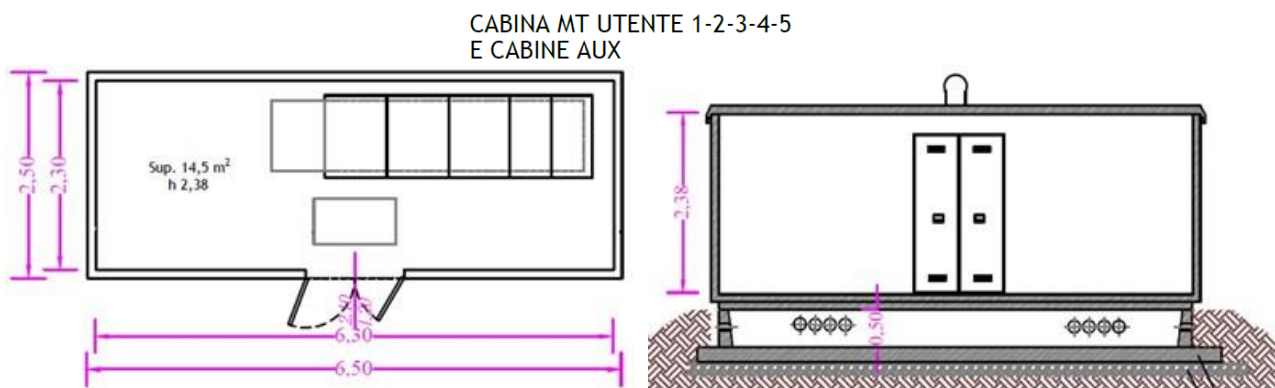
Pianta e profilo delle cabine MT utente 1-2-3-4-5 e cabine aux
